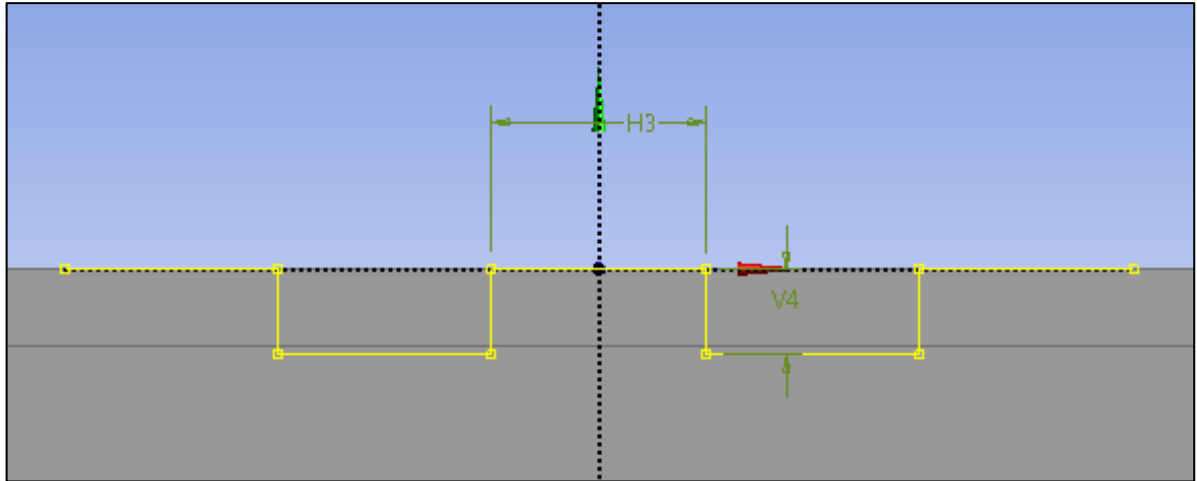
Parâmetros da viga do teto próxima a Coluna "A"
